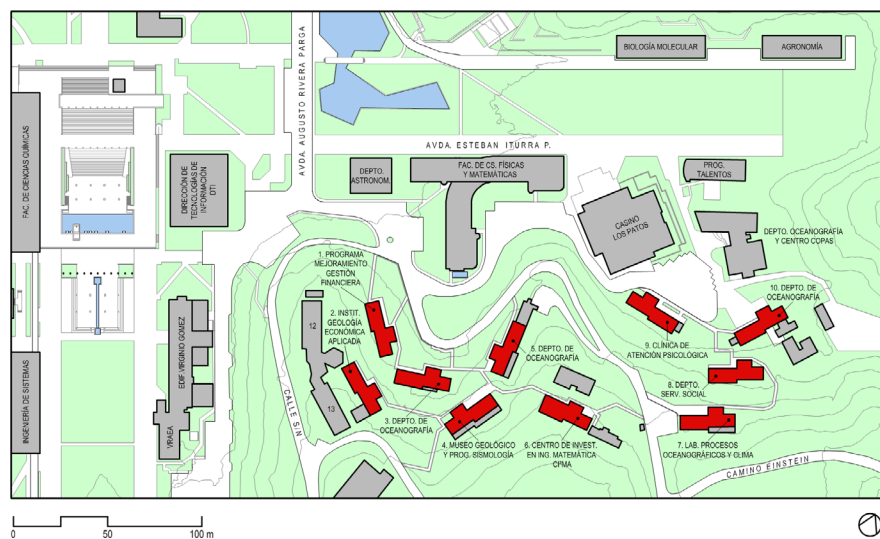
Plano de conjunto, 2022 (fuente: Elaboración propia en base a levantamiento topográfico DIRSER, 2022).
